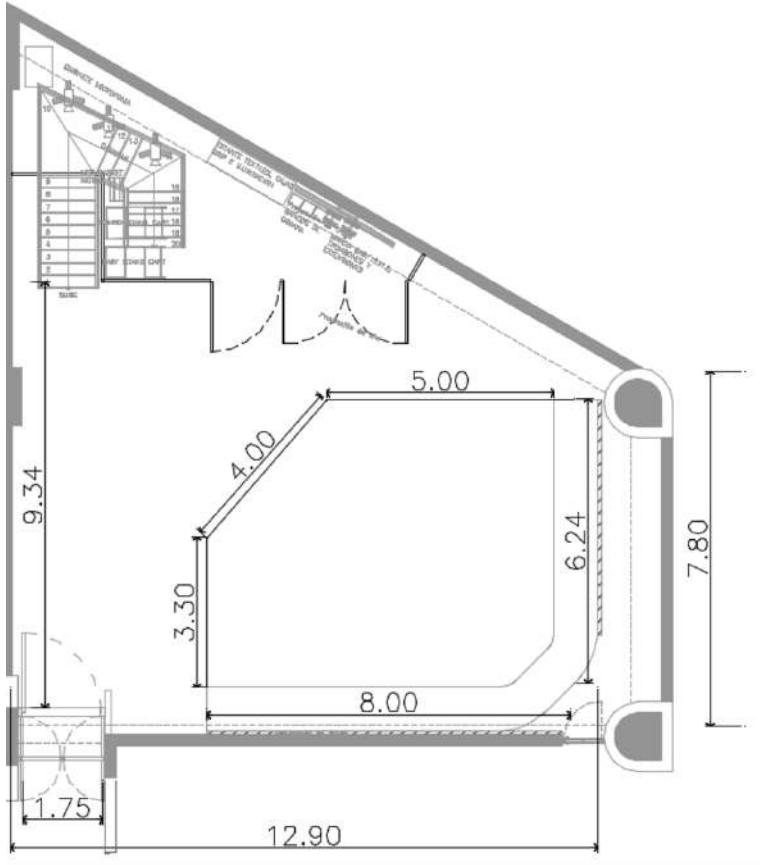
| PLANTA DEL FORO - CICLORAMA Y FONDOS SEAMLESS
